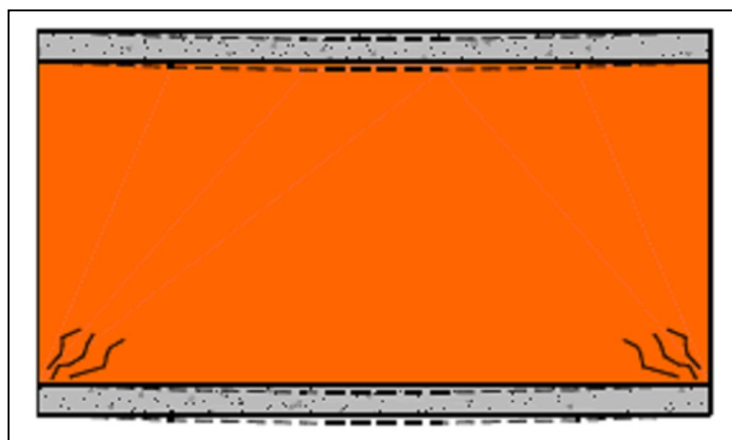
Fissuração em parede de compartimentação: Deformação do suporte idêntica à deformação da viga superior. [37]
